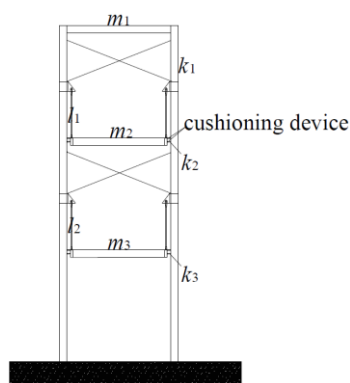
Конструктивная схема здания с подвешенными перекрытиями
